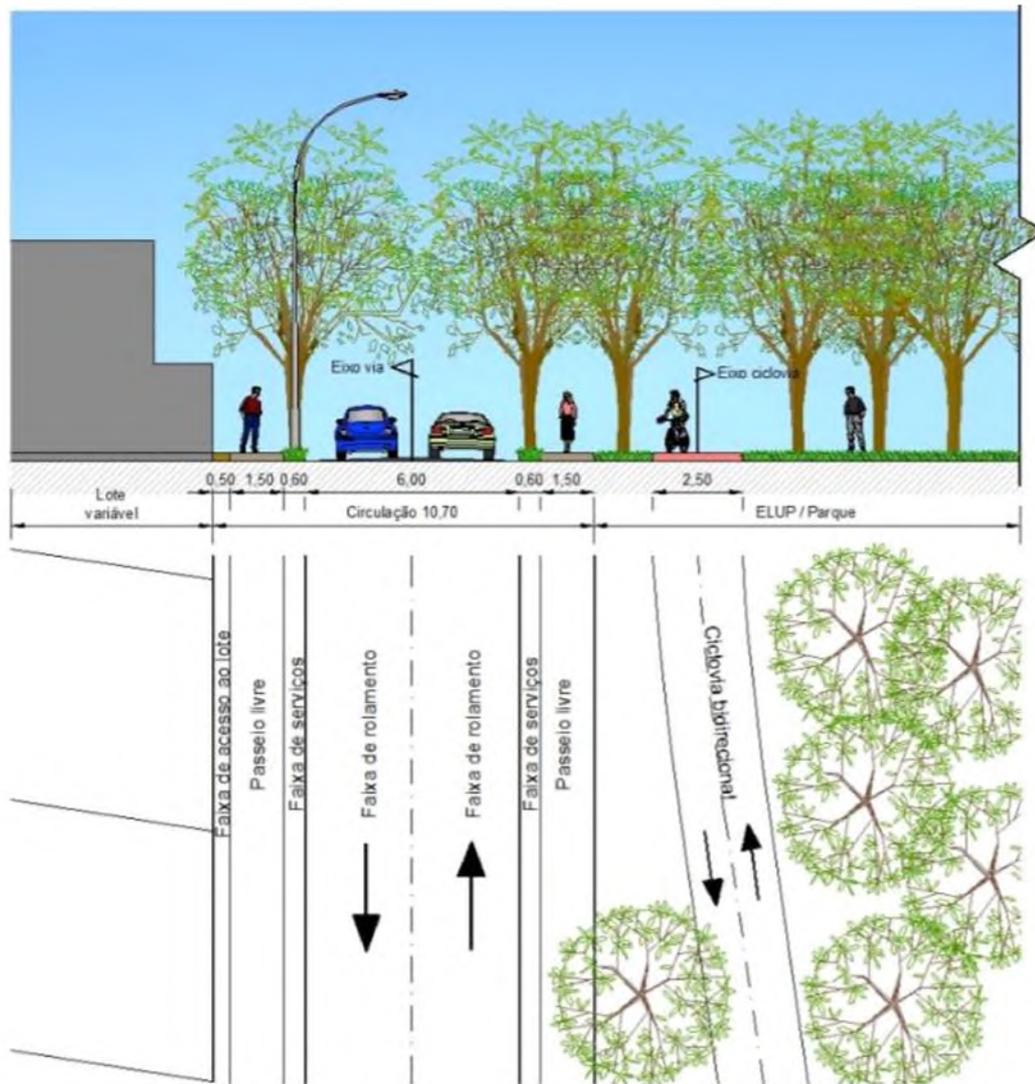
Perfil 02 da Rua Parque (Fonte MDE-EP)
